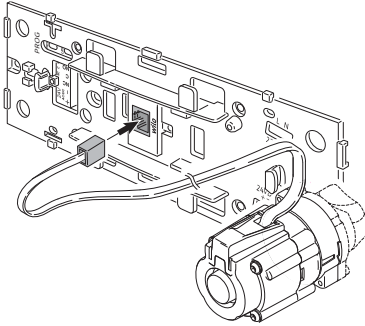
Pumpenkabel am Modul Heatfixx aufstecken
